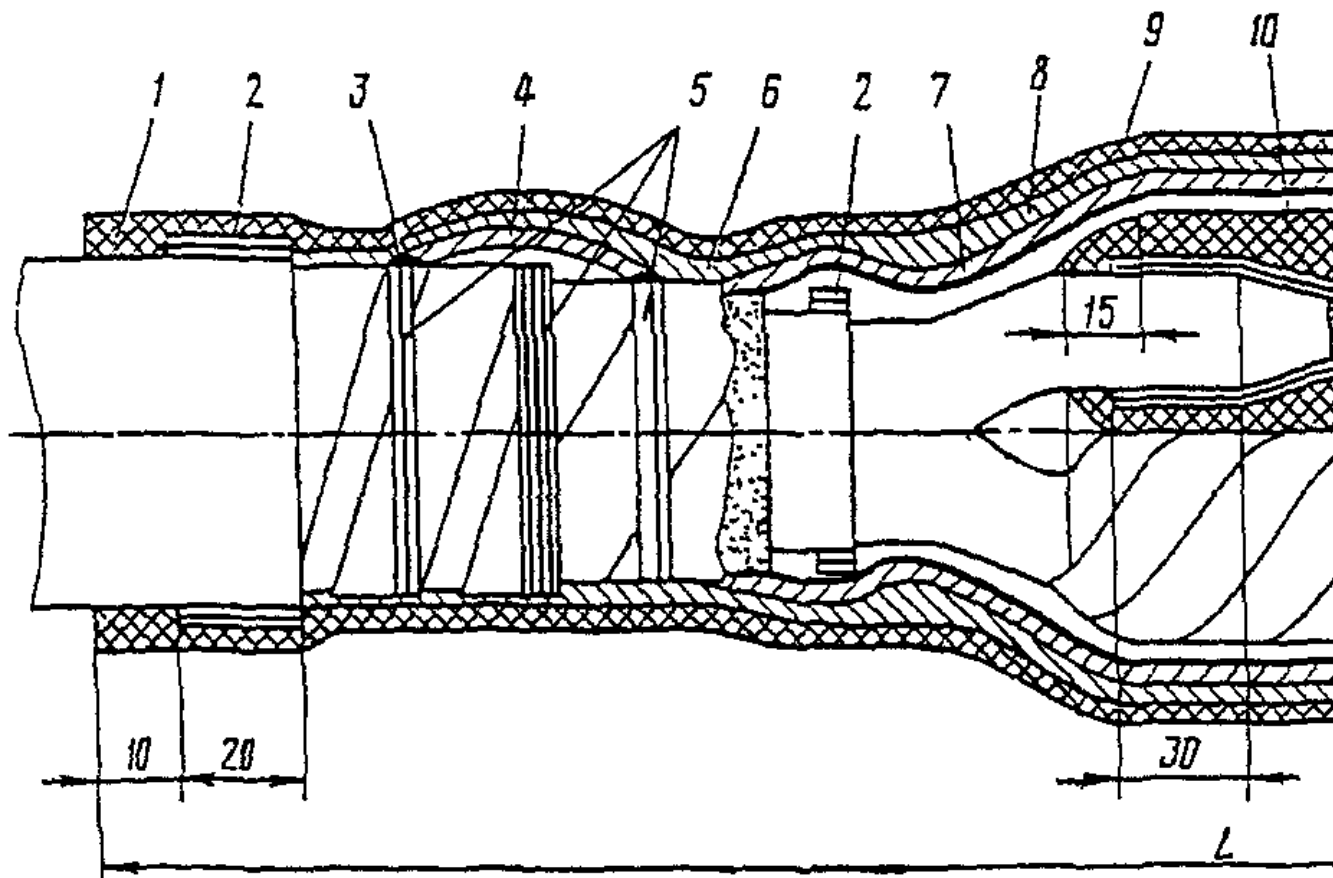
Соединительная муфта напряжением 6 кВ: 1 - восстановленный наружный покров (трубка термоусаживаемая или лента ЛЭТСПАР); 2 - адгезионные прослойки; 3 - пайка провода заземления; 4 - провод заземления; 5 - бандаж; 6 - подмотка лентой из ПВХ пластиката; 7 - восстановленный металлический экран; 8 - восстановленный полупроводящий экран; 9 - общая подмотка лентой ЛЭТСПАР (поясная изоляция); 10 - восстановленная изоляция жилы (из ленты ЛЭТСПАР); 11 - гильза соединительная
